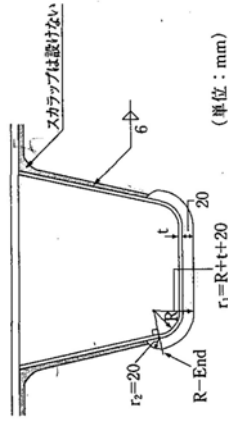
閉断面リブと中間横リブまたは横げたとの交差部構造の標準
